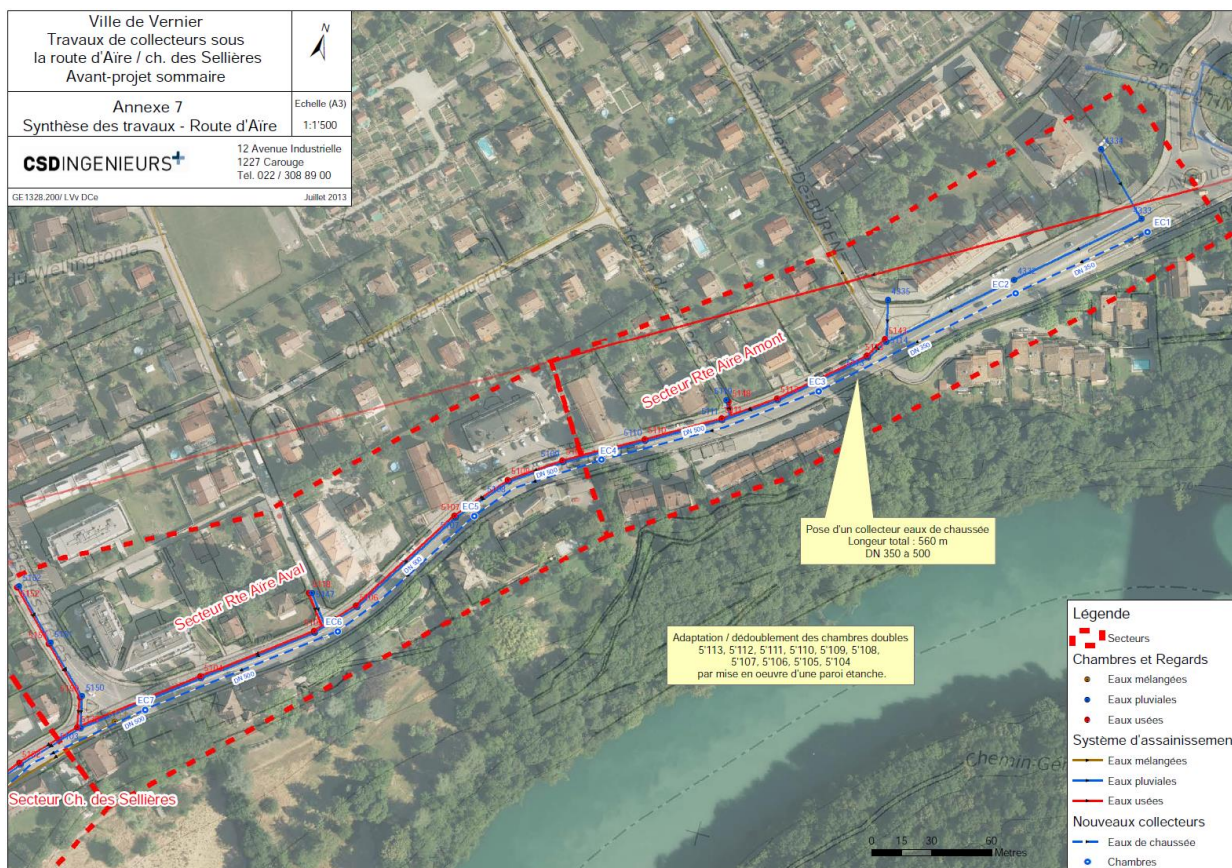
Travaux d'assainissement projetés sous la route d'Aire
